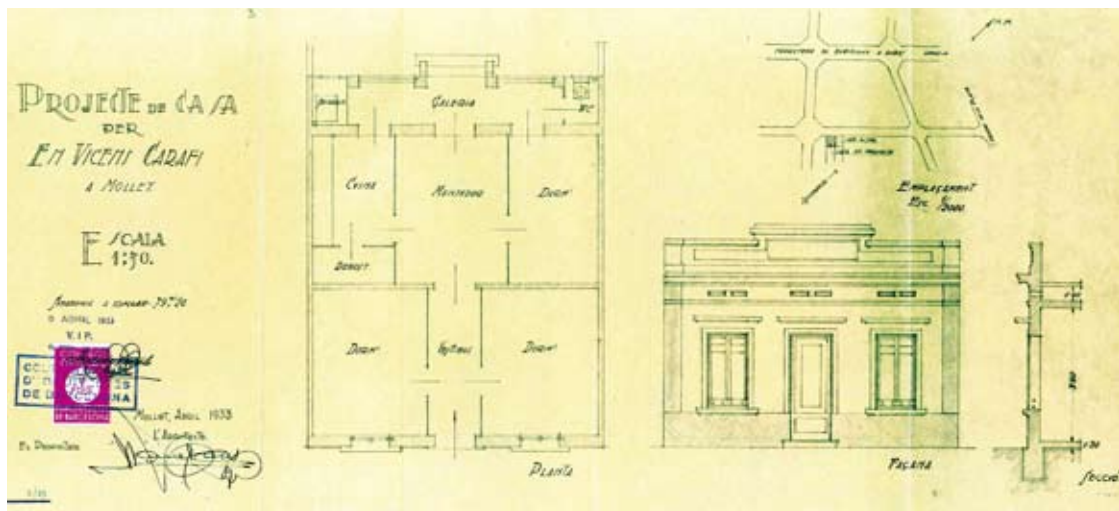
Planta, emplaçament, façana i secció del projecte de casa de Vicens Carafí, el 1933.
